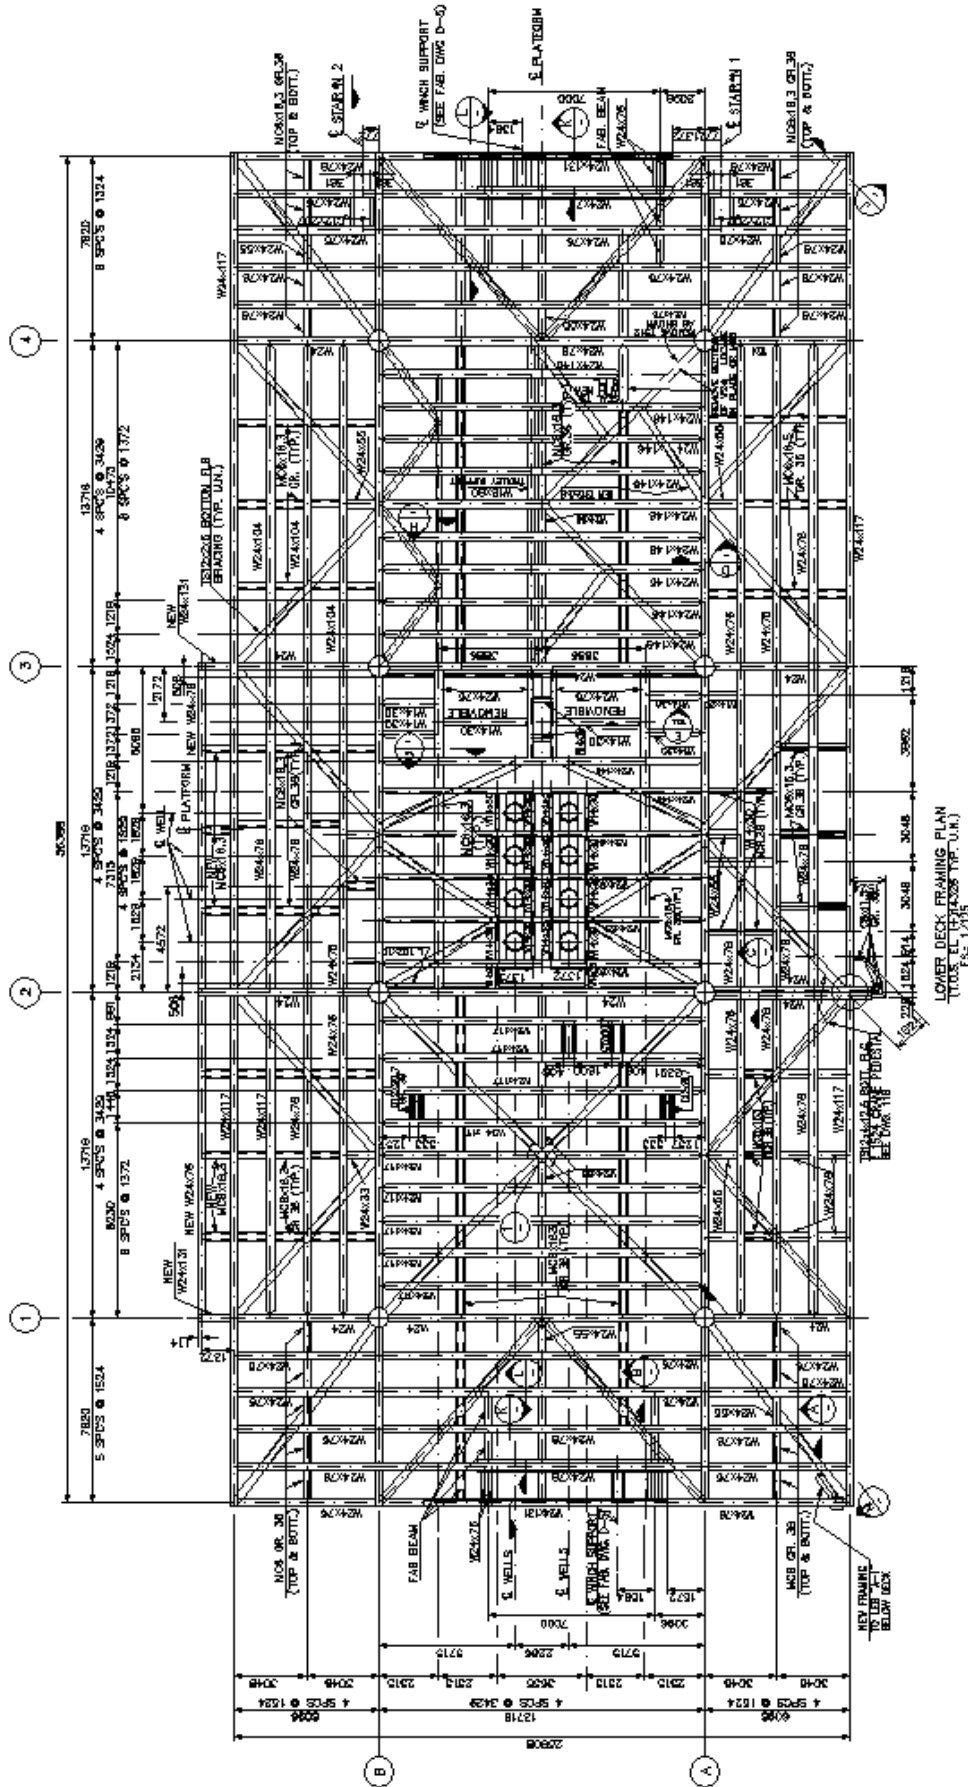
Planta baixa do convés inferior (cotas em mm)
